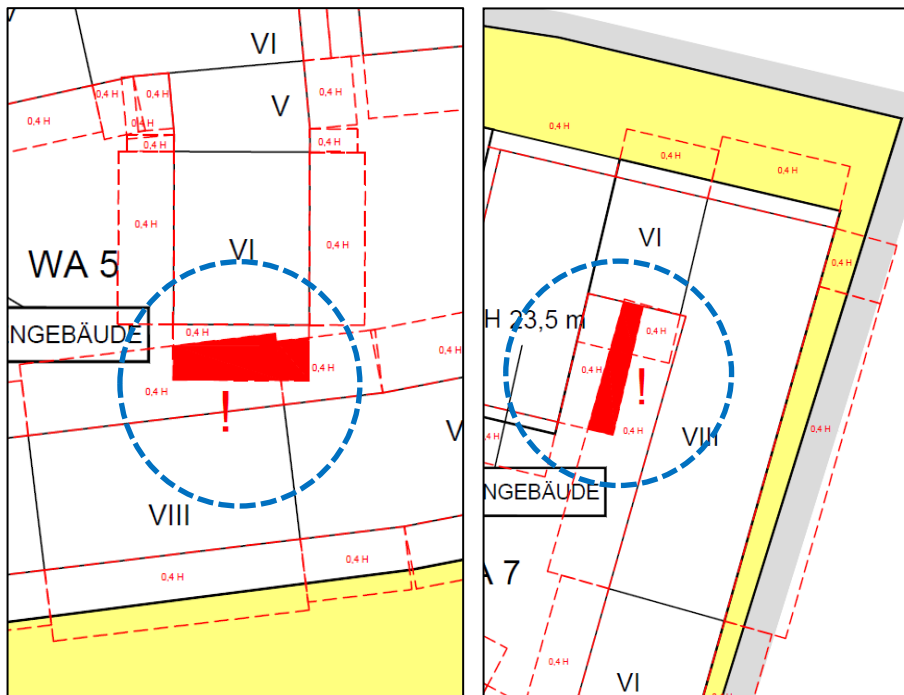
und 3b: Ausschnitte aus dem Abstandflächenplan (ohne Maßstab),
